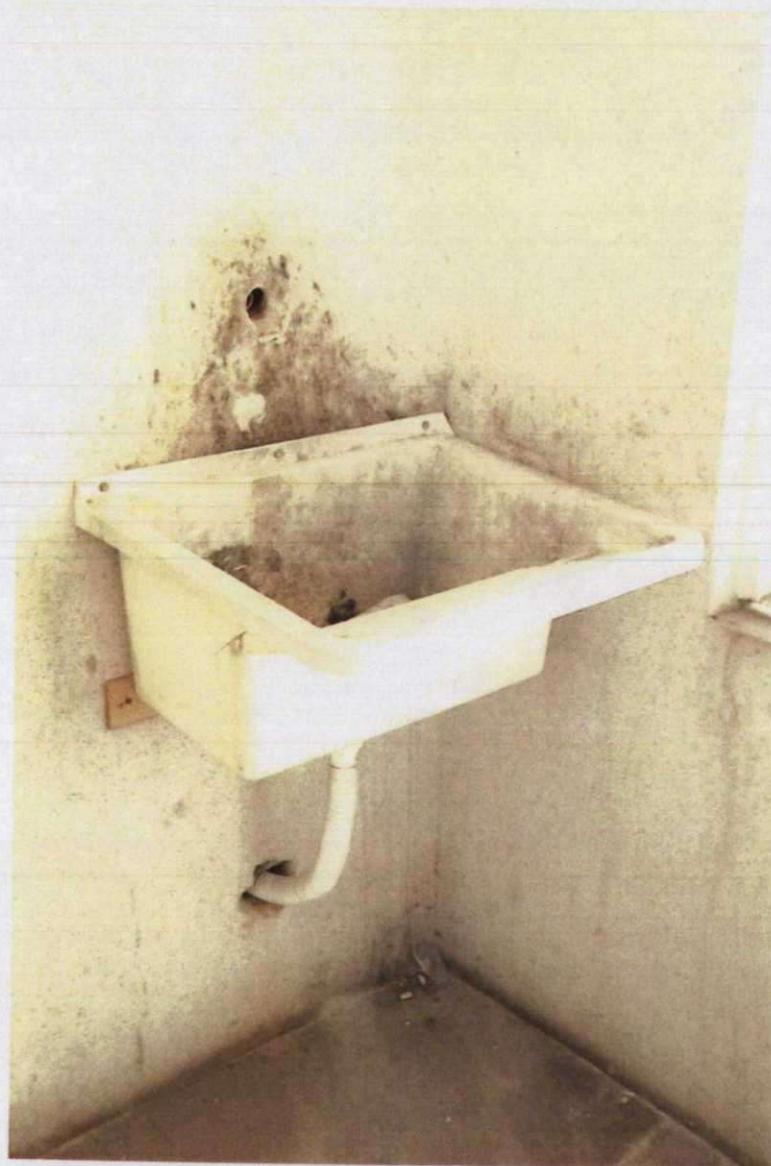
DETALHE DO TANQUE NO HALL PRIVATIVO
